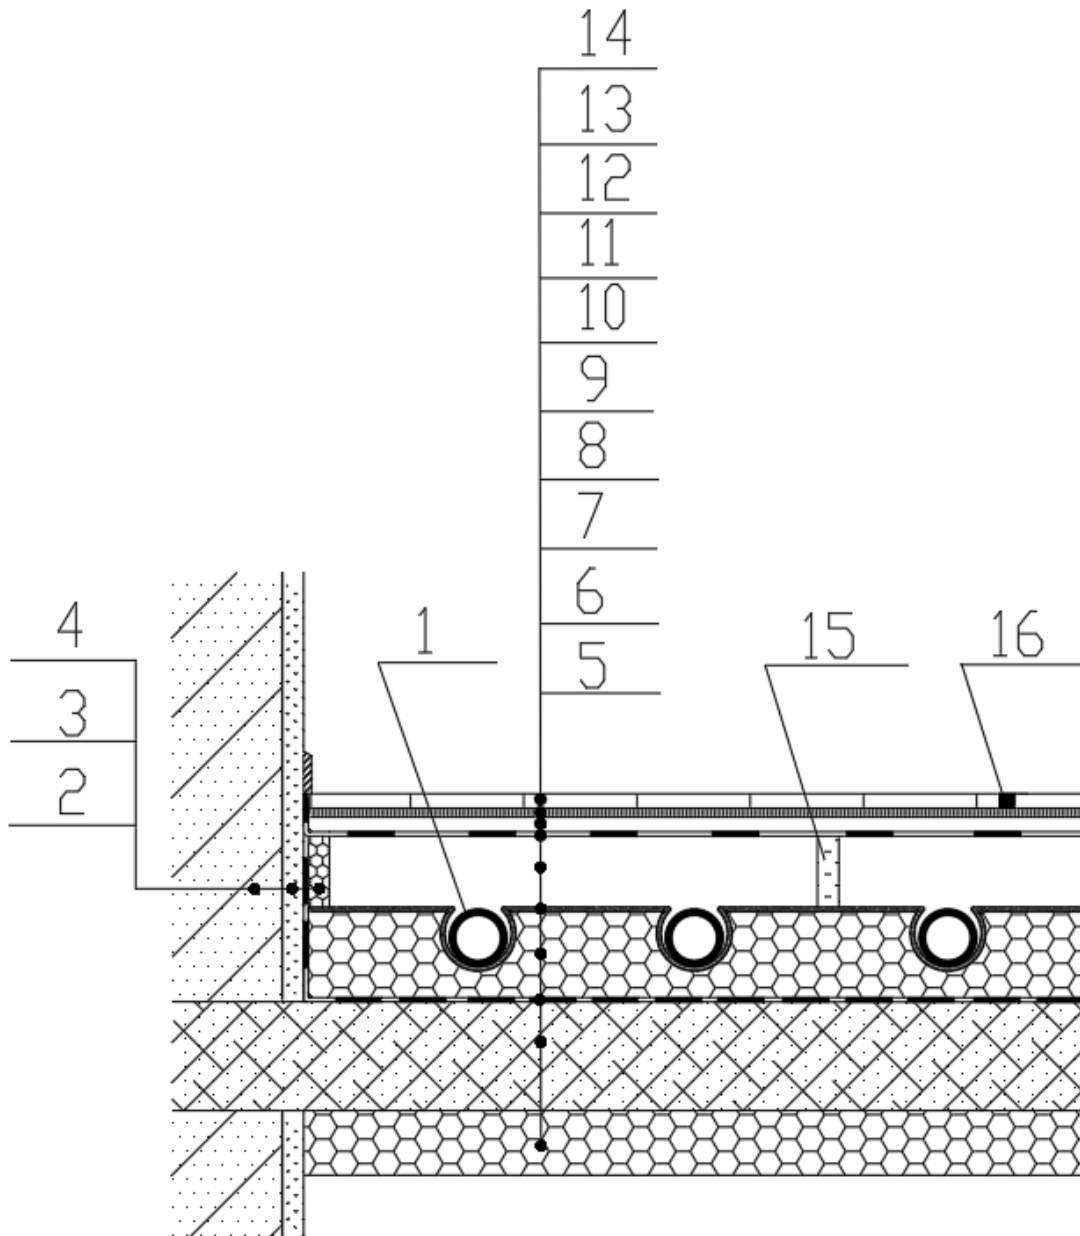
采用预制沟槽保温板的混凝土填充式热水地暖地面构造
